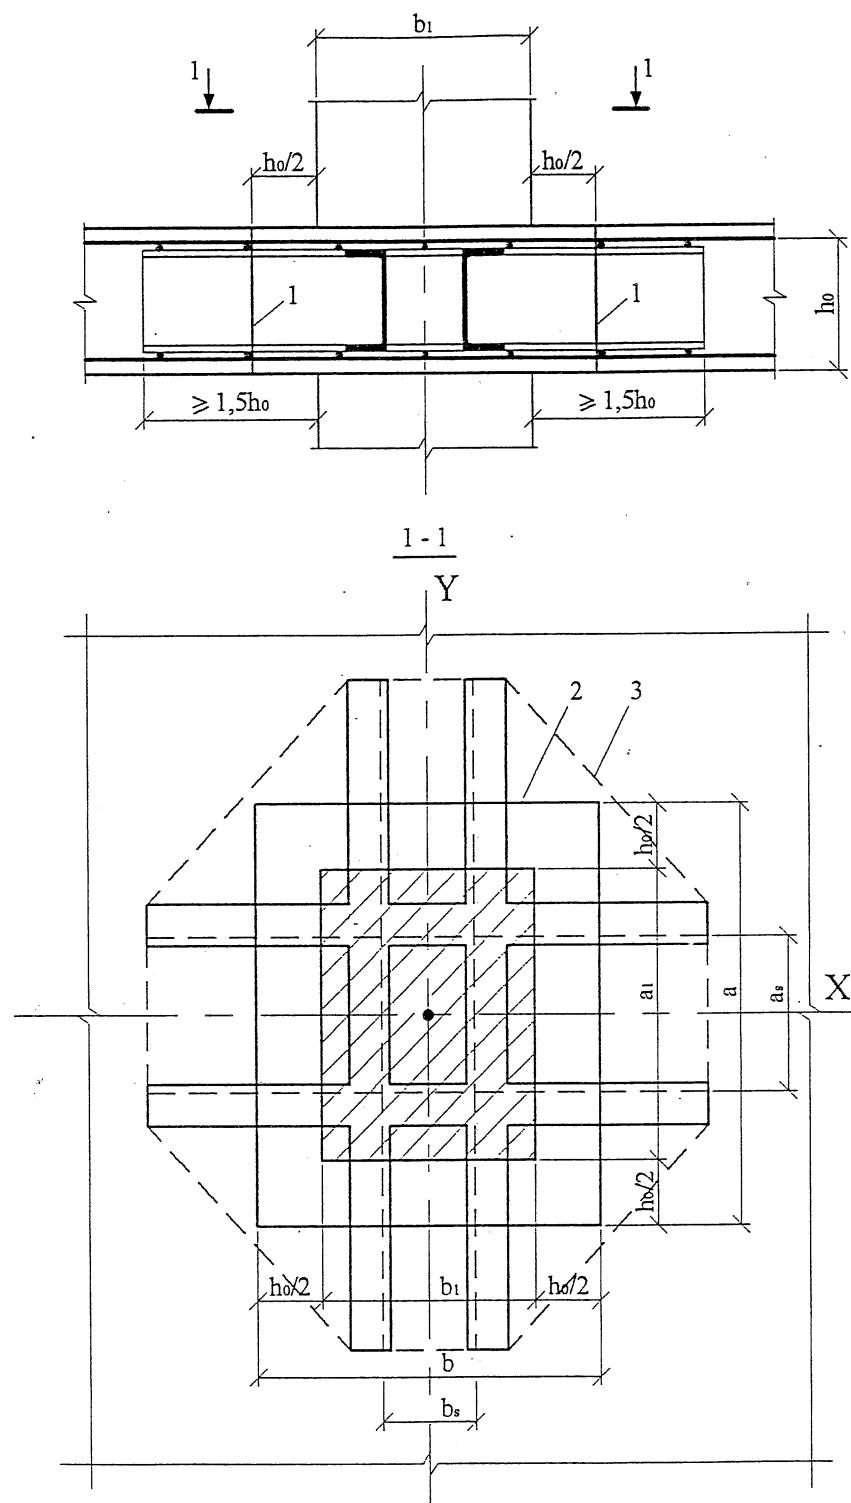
Схема для расчета железобетонных плит на продавливание с жесткой поперечной арматурой
